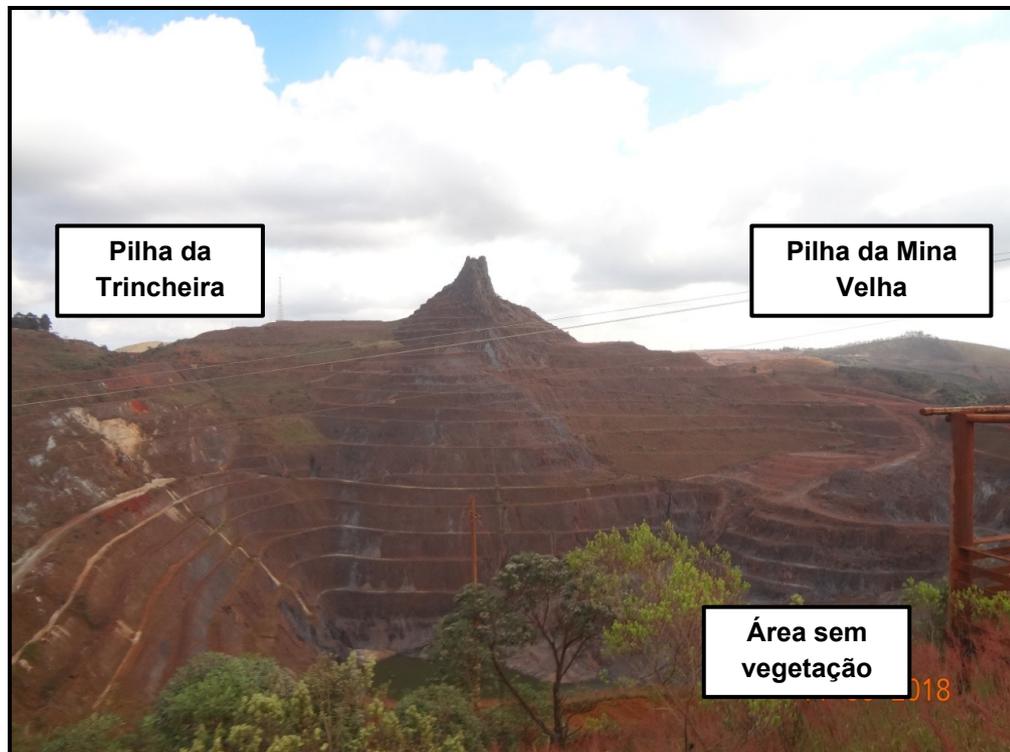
Vista frontal do Pico do Itabirito com as pilhas de disposição de estéril.
